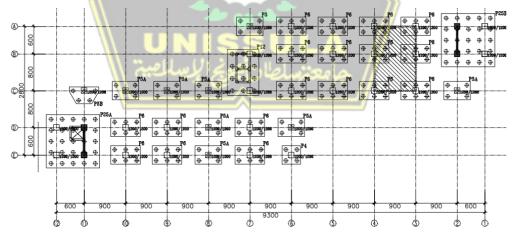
Denah Lantai 1 Sumber: DED Proyek
